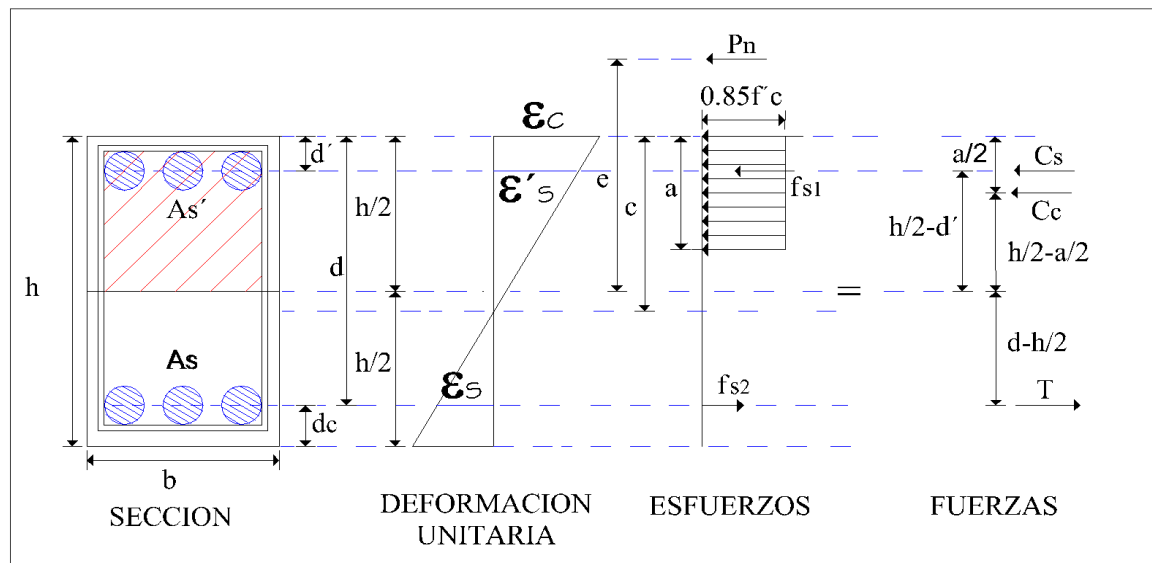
Sección rectangular de concreto doblemente reforzada (Fuente: Figura 8.8. "Diseño de Estructuras de Concreto". Arthur N.)
